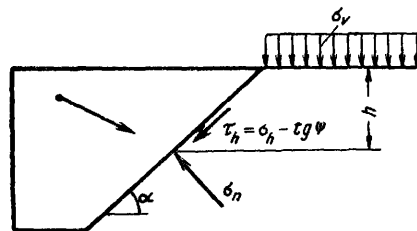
Схема пассивного отпора грунта перед наклонной стенкой
